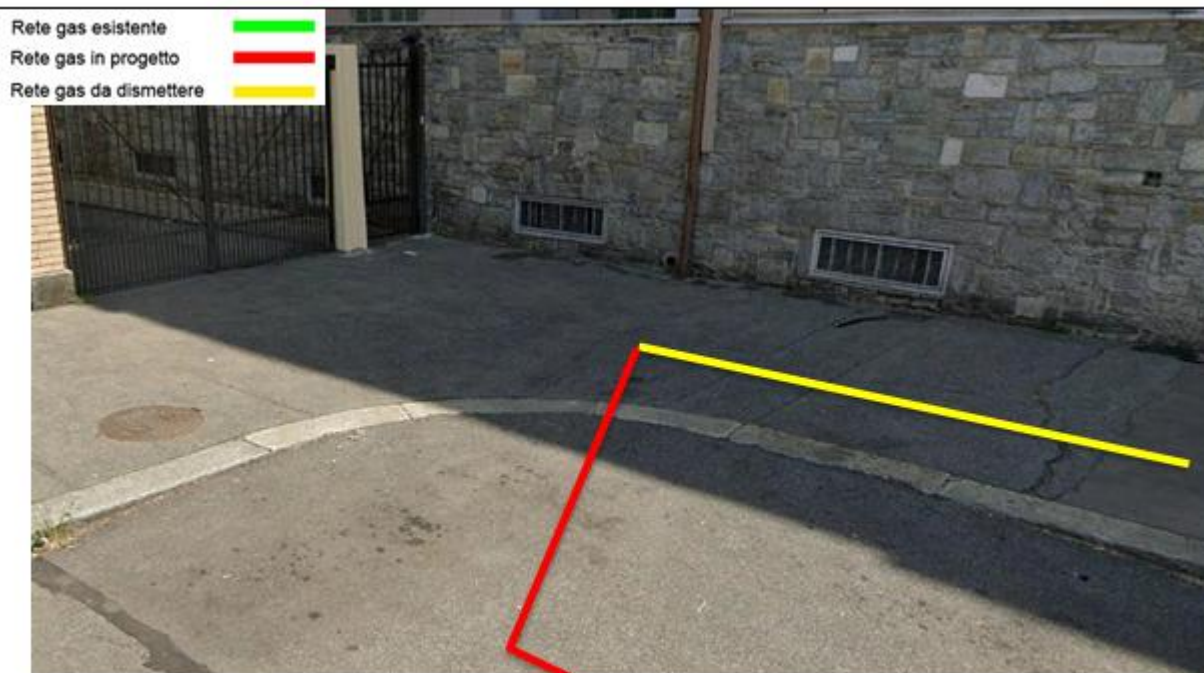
Termine derivazione condotta Piazza Fabio Filzi
